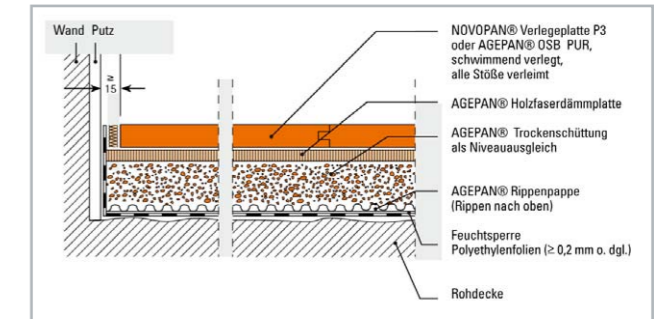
Das schwimmende Verlegen auf Stahlbetondecken mit AGEPAN® Dämmplatten natur und AGEPAN® Trockenschüttung (Kombinationsaufbau).
